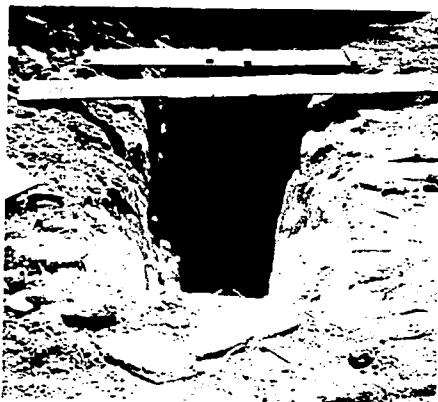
Lumbreras excavadas con la mini – retroexcavadora.
